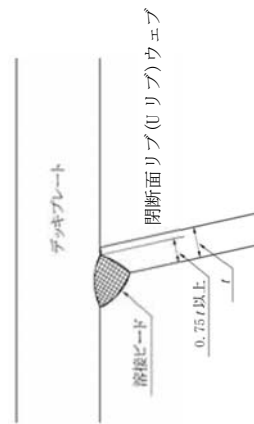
縦リブとデッキプレートの溶接の溶込み量
